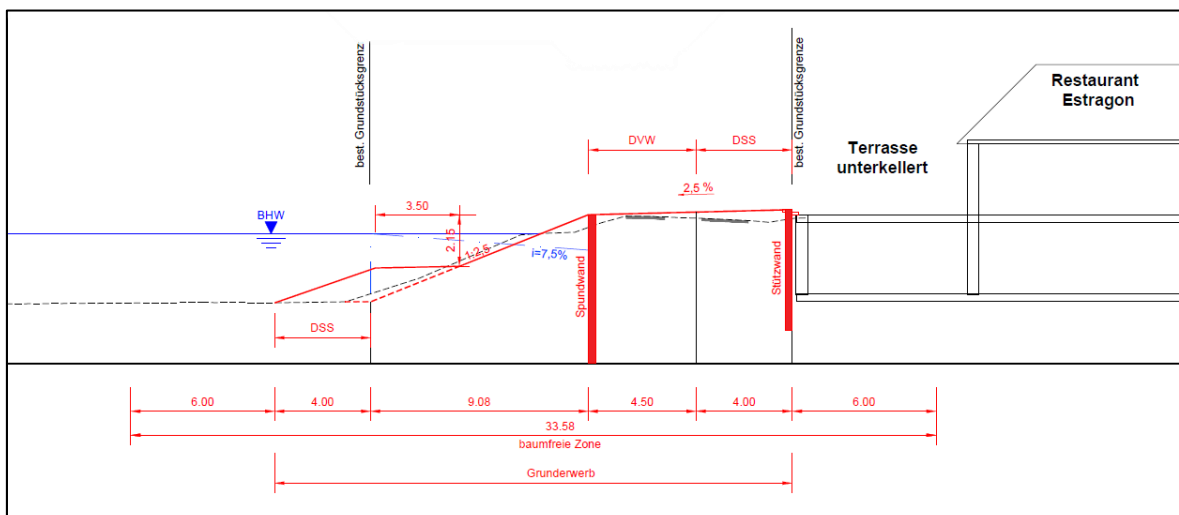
Dammprofil Damm-km 0+890,00 Estragon
